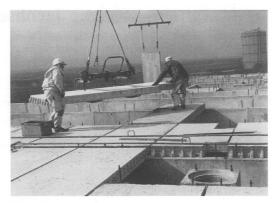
Jespersen & Søn. Sistema de losas prefabricadas para la construcción de viviendas plurifamiliares (Meyer-Bohe, W. 1969)
